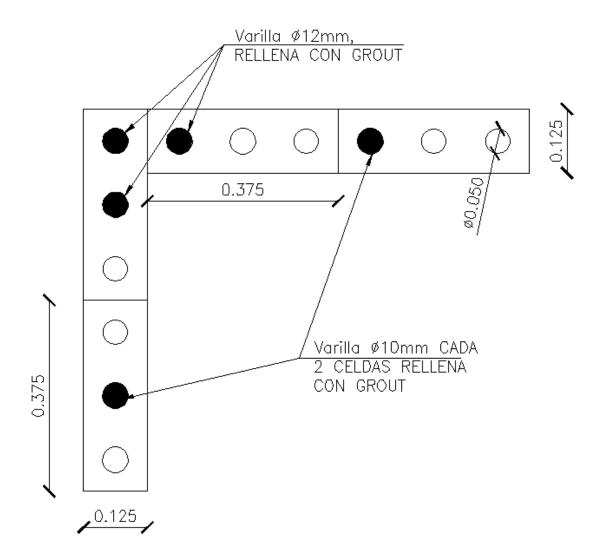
Refuerzo longitudinal y transversal en muro MY6-MY7
